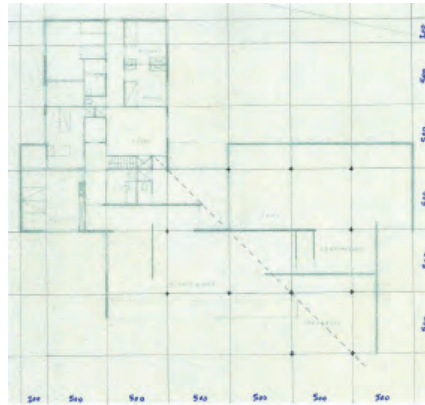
Planta de la casa Nolde, Berlín, 1929. Ejes y acotación del autor sobre planimetría de MvdR.
